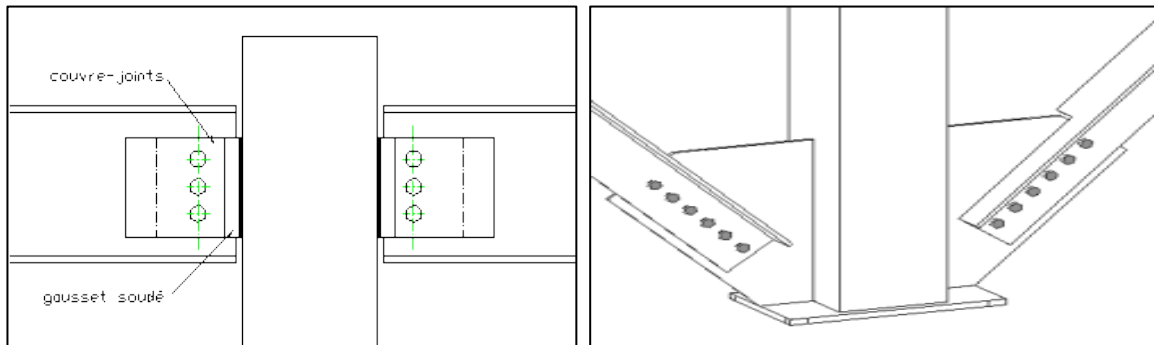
Gousset soudé sur l'aile ou l'âme du poteau
